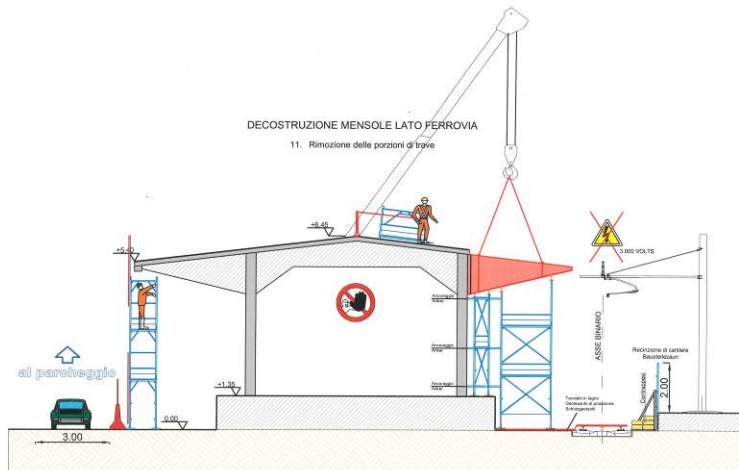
Sezione Demolizione Edificio A9 – Rimozione porzione di trave
